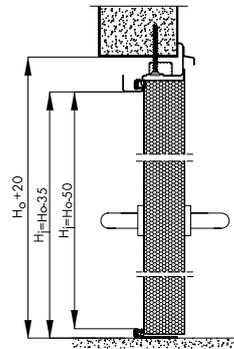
Montage zweiflügeliger Türen mit Eckzarge an der Stahlkonstruktion - Vertikalschnitt.
